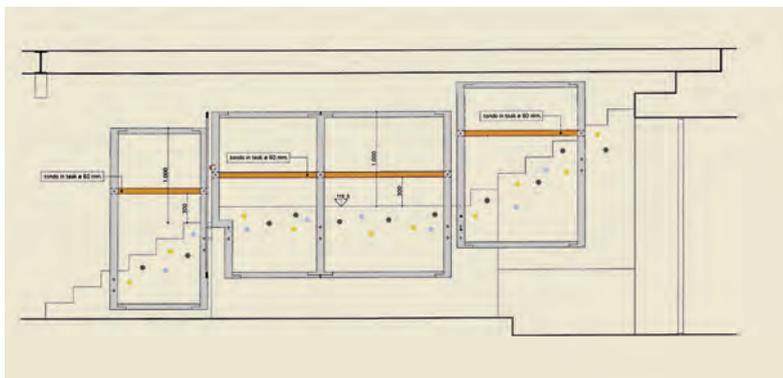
Particolare del progetto del parapetto a firma dell'architetto Fabio Lombardo.
